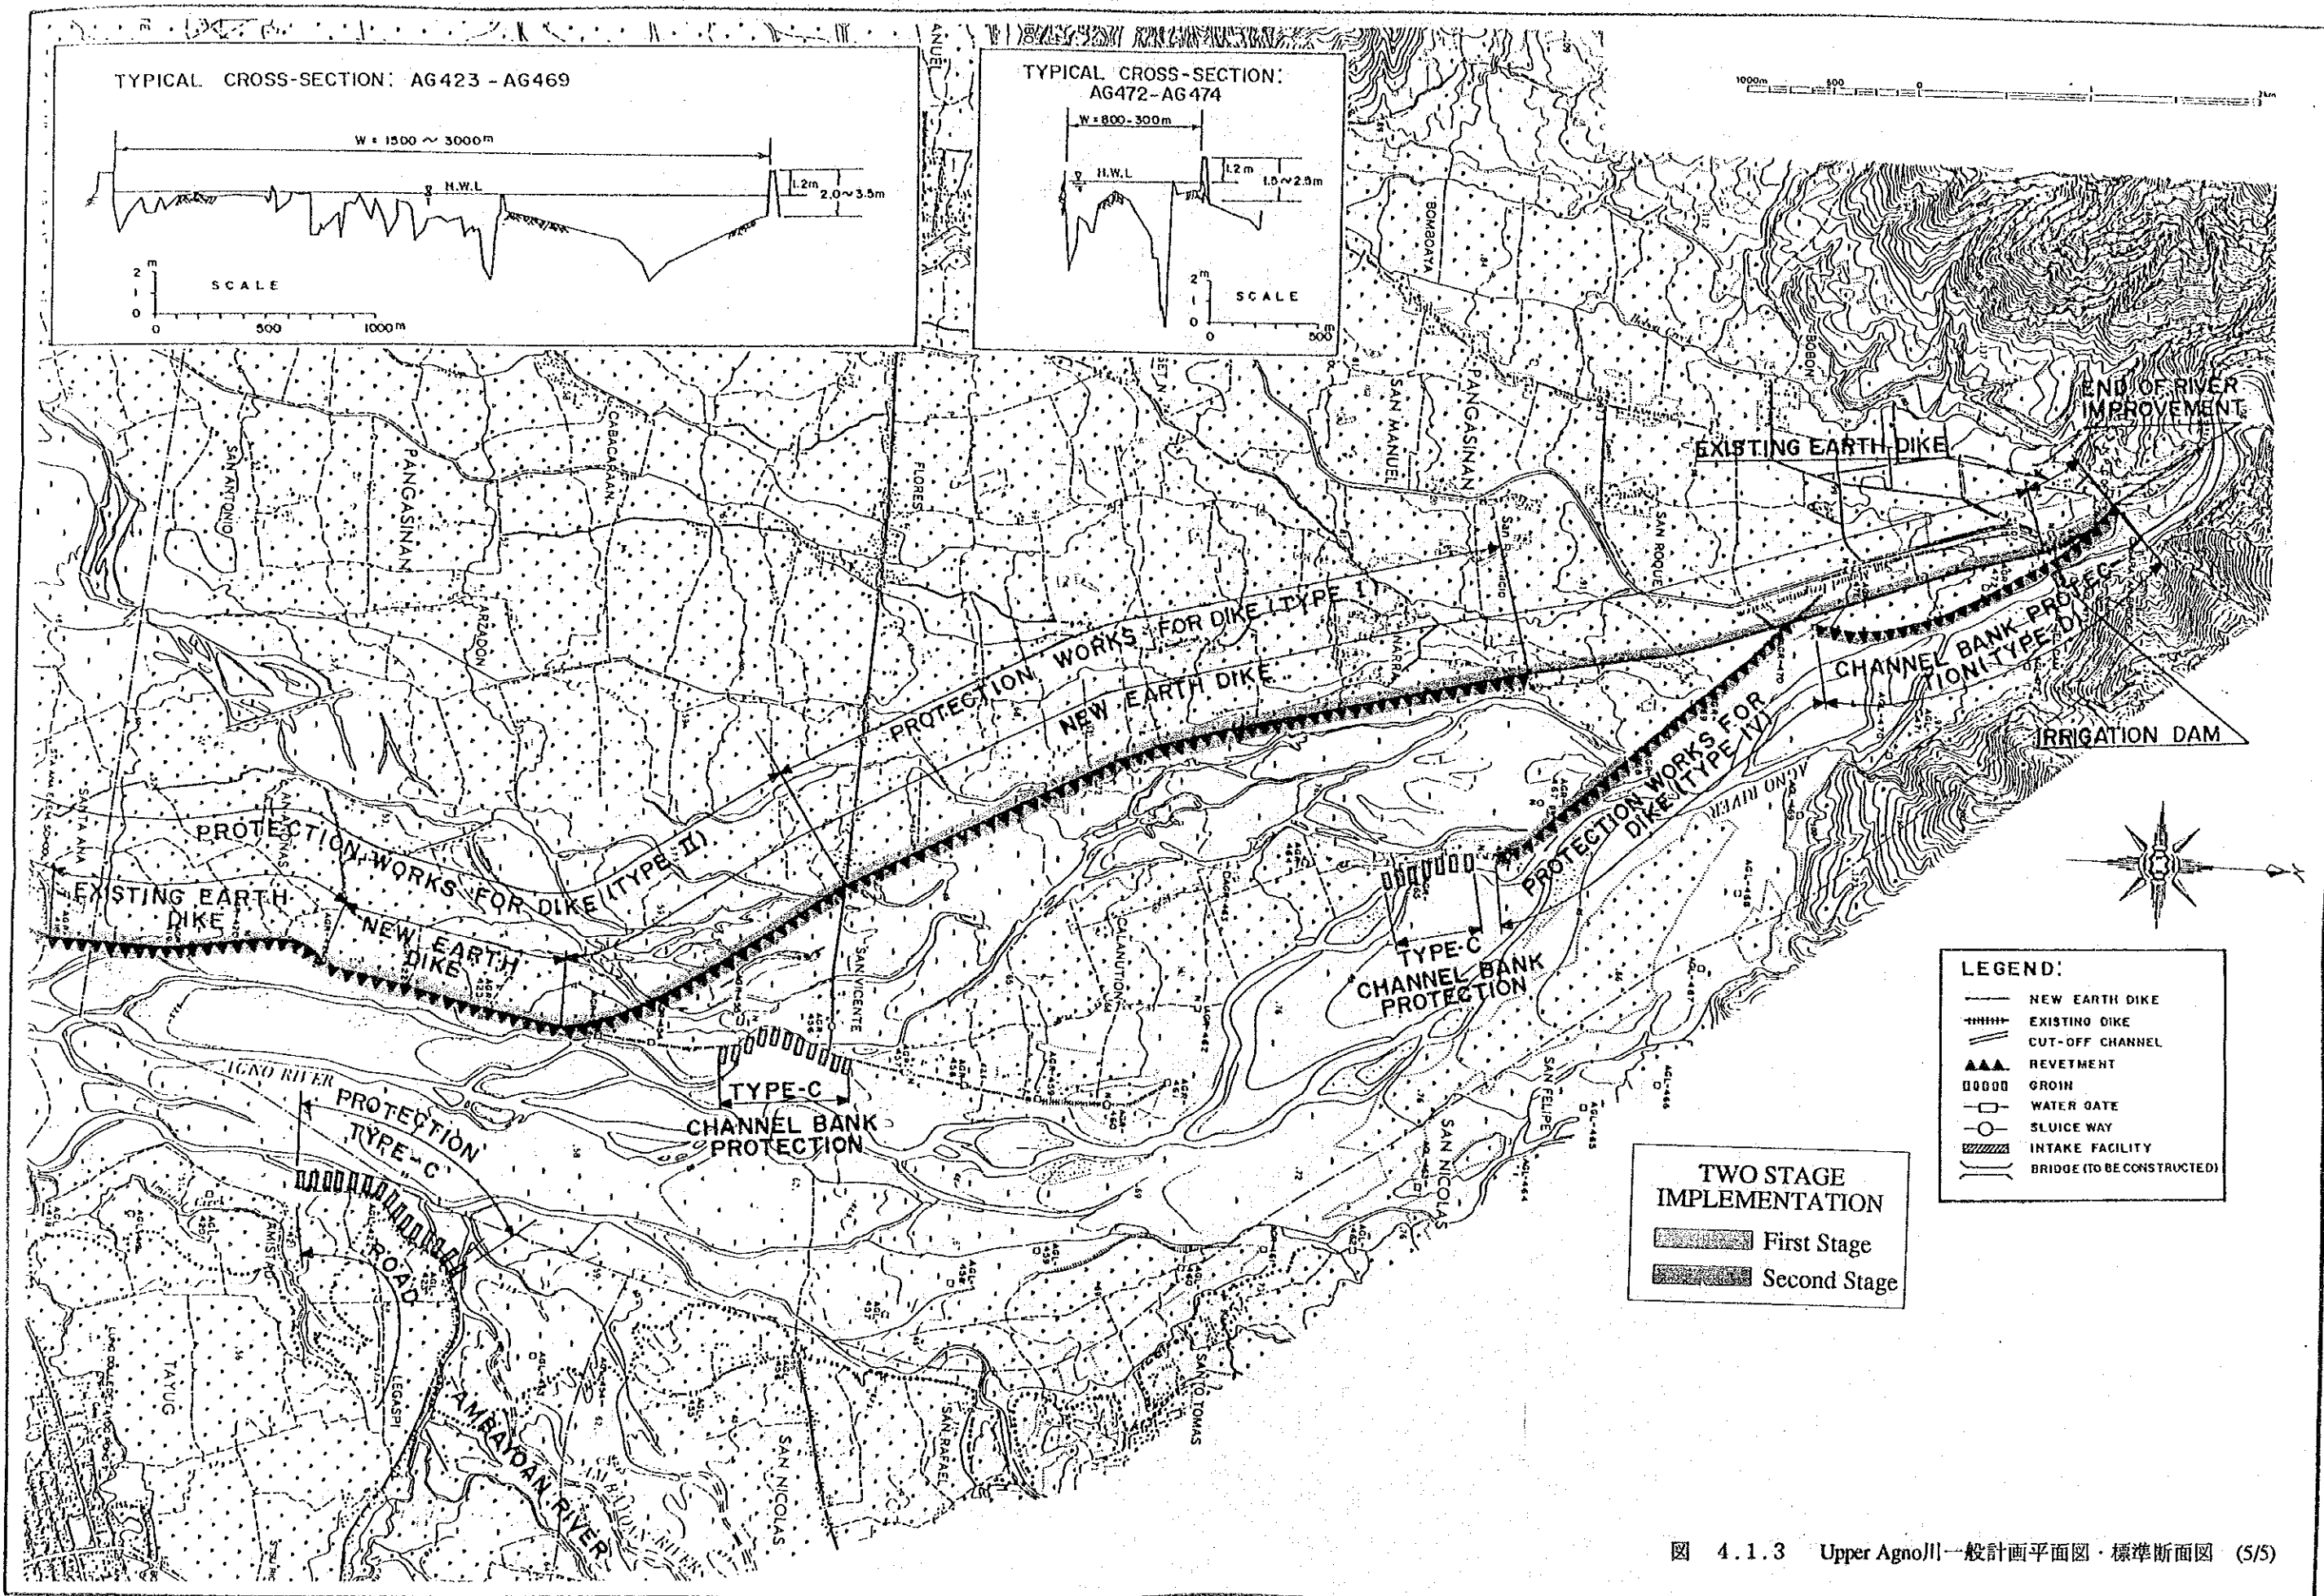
Upper Agno川一般計画平面図・標準断面図 (5/5)
